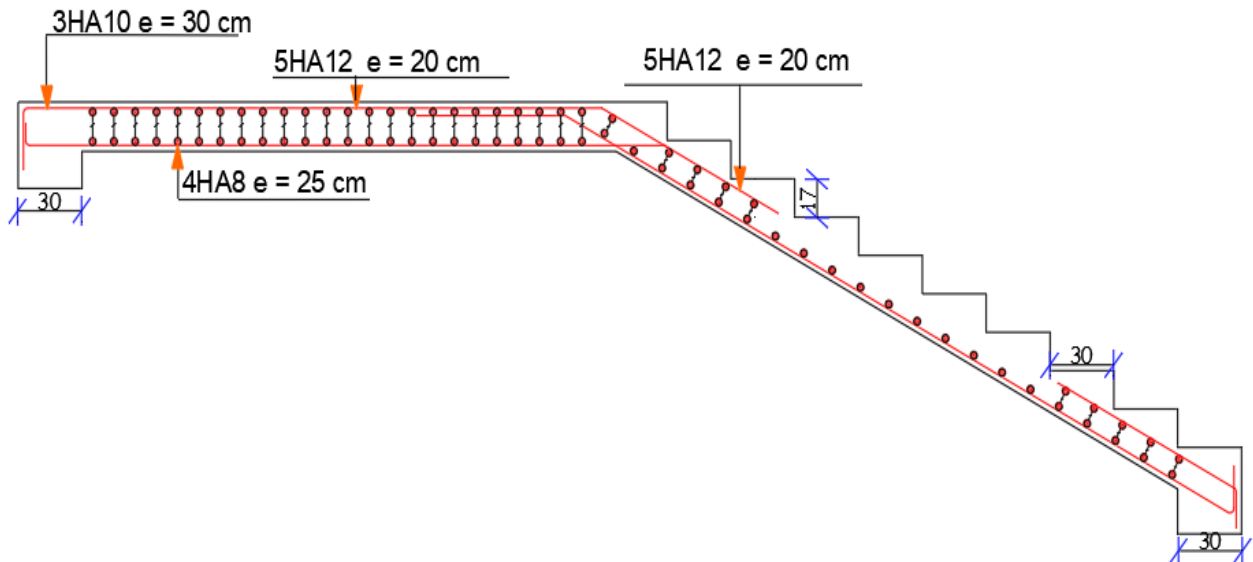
Schéma de ferrailage de l'escalier étage courant.
